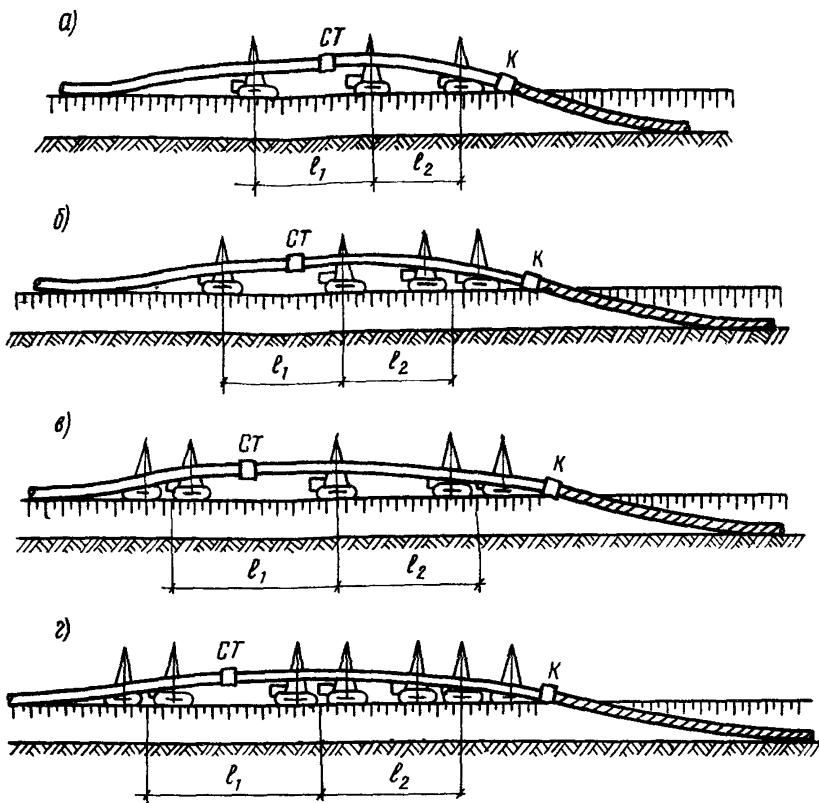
Схемы расстановки трубоукладчиков и машин в изоляционно-укладочной колонне при совмещенном способе производства работ для трубопроводов различных диаметров:
